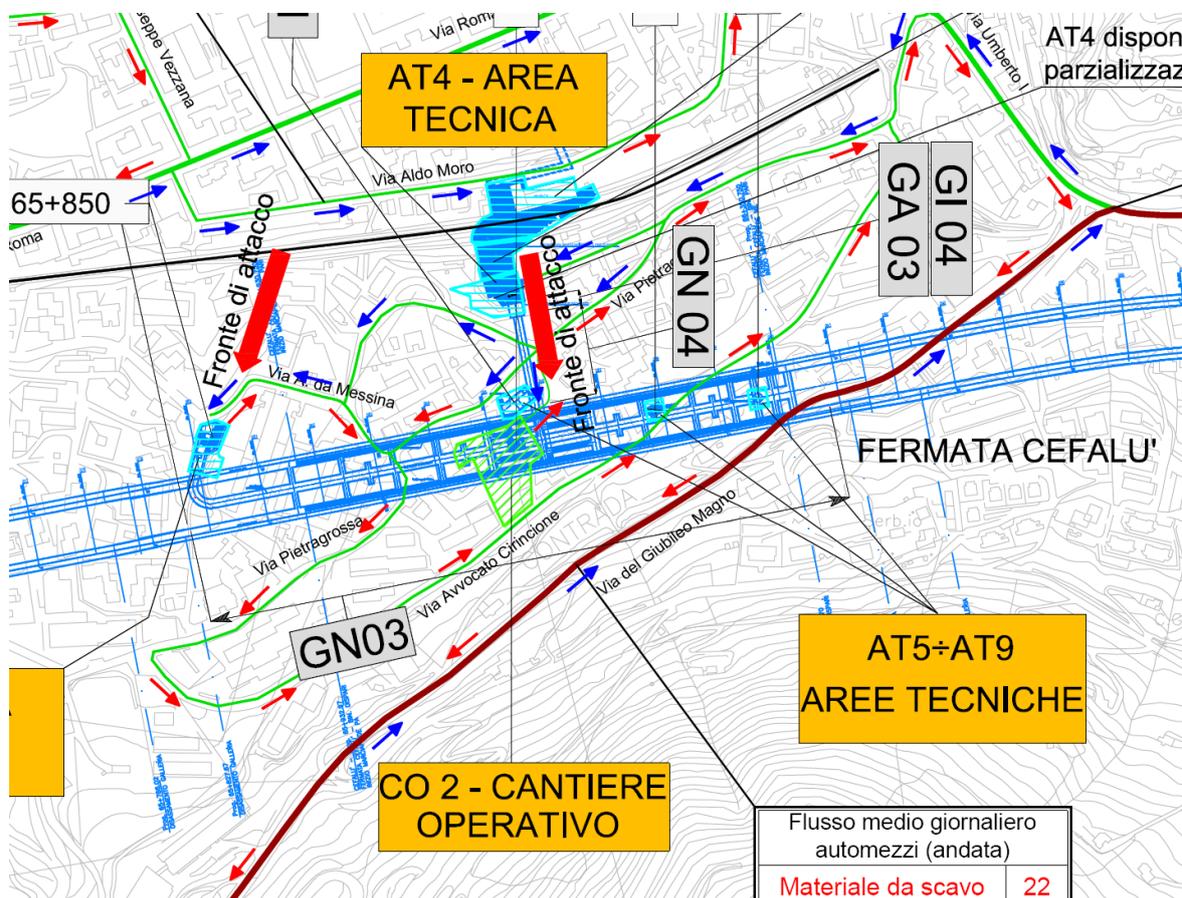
Stralcio planimetrico della Zona Fermata Cefalù, con indicazione dell'area di cantierizzazione CO2.
